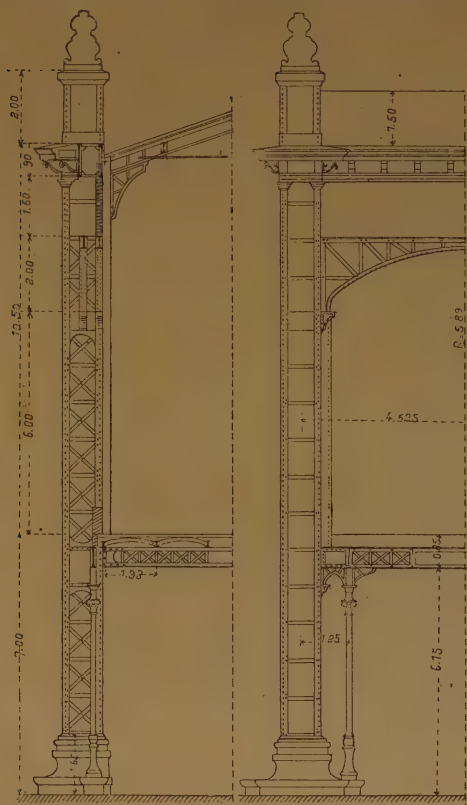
Palais des Arts: Détails d'une travée de la façade.
